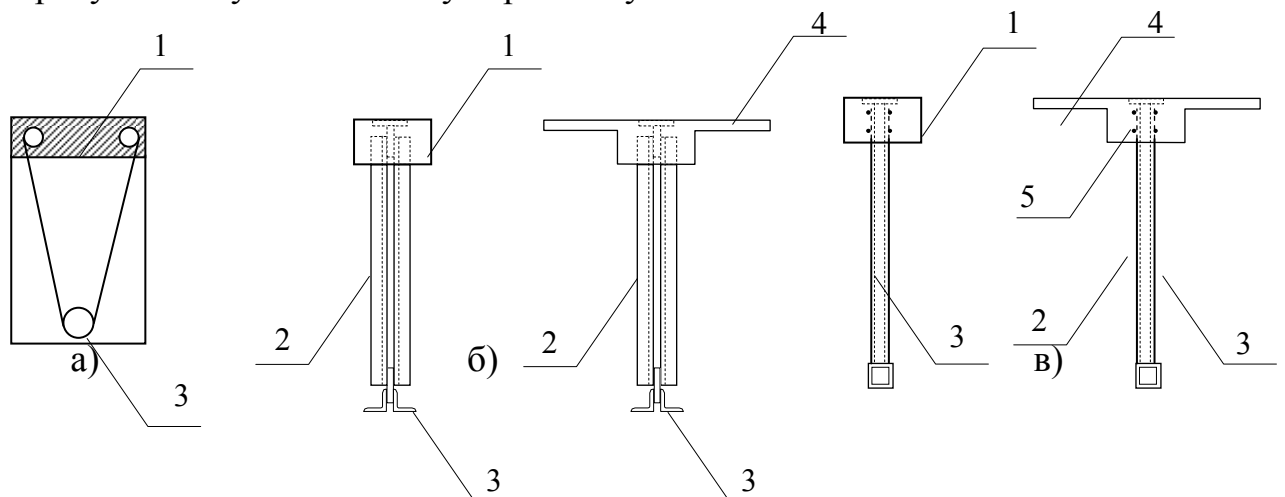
Поперечні перерізи конструкцій з винесеною робочою арматурою:
